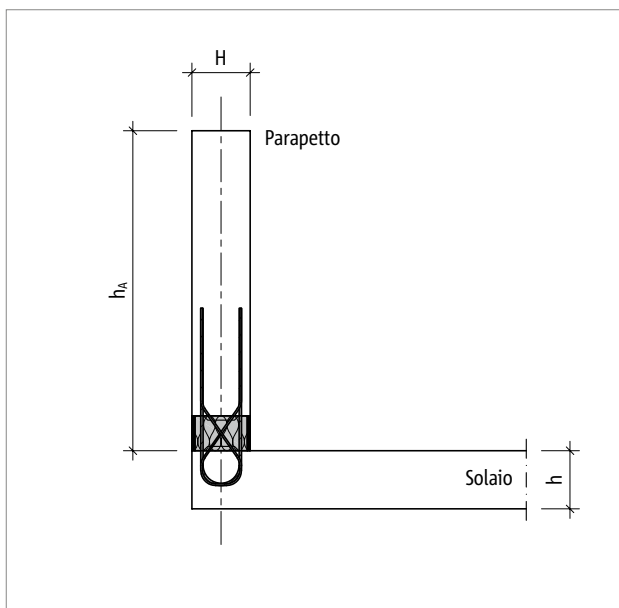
Schöck Isokorb® XT tipo AP: schema statico con altezza del parapetto  $h_A$
